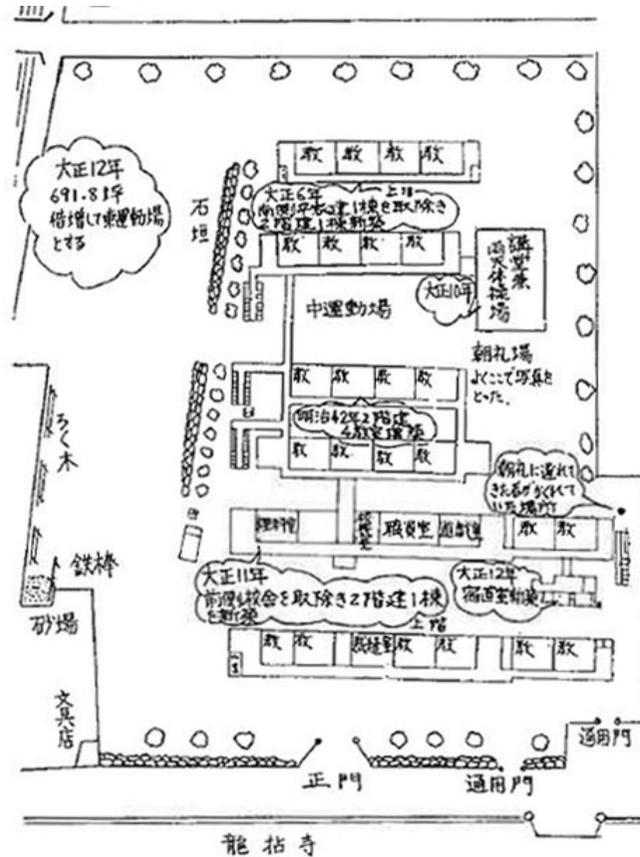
当時の新川小学校平面図（図の上端及び下端の平面図は2階部分を示す）
